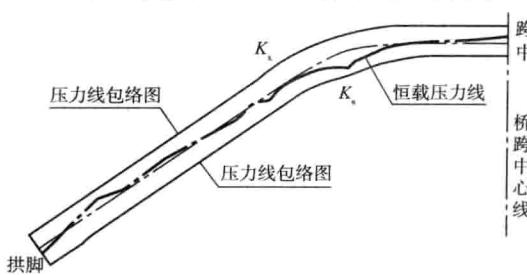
预应力混凝土八字形刚架拱桥压力线包络图
